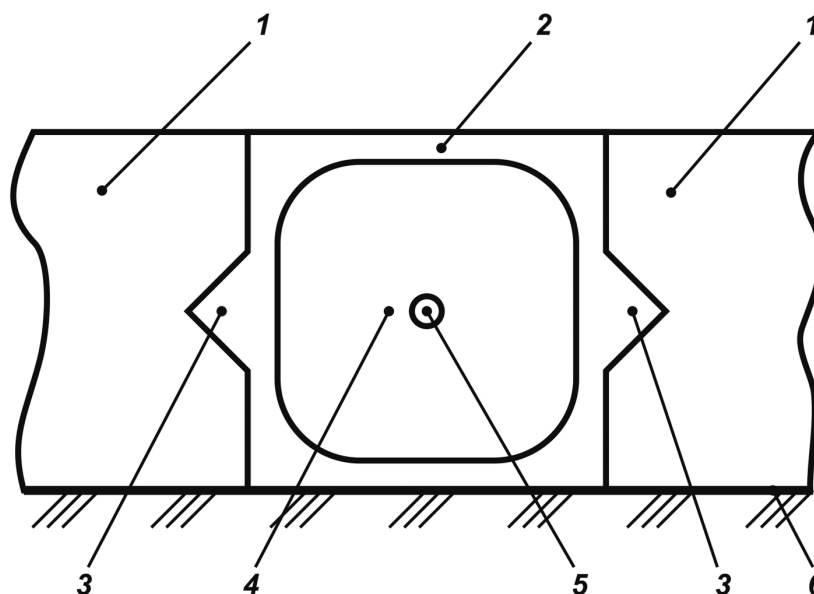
Пневматическое стыковое соединение сборно-разборного покрытия автомобильной дороги (вид сбоку)
